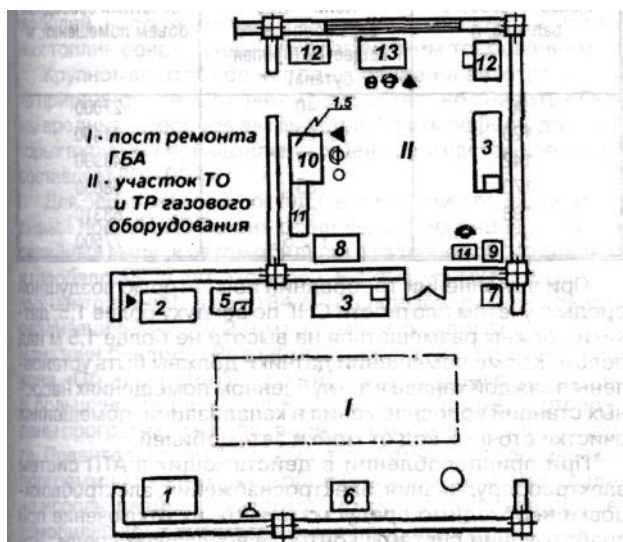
Планировка отделения по ТО и Р газобаллонных автомобилей: 1 - мотор-тестер, 2 – стенд для проверки герметичности газового оборудования, 3 – шкаф-стеллаж для хранения газового оборудования, 4 – анализатор отработавших газов, 5 – подставка под оборудование, 6 - стол приемки, 7 – ларь для отходов, 8 – тележка для газовых баллонов, 9 – ящик с песком, 10 – стенд для проверки и регулировки газового оборудования для СНГ, 11 – установка для мойки деталей, 12 – верстак слесарный, 13 – стенд для проверки и регулировки газового оборудования для КПП, 14 – умывальник
